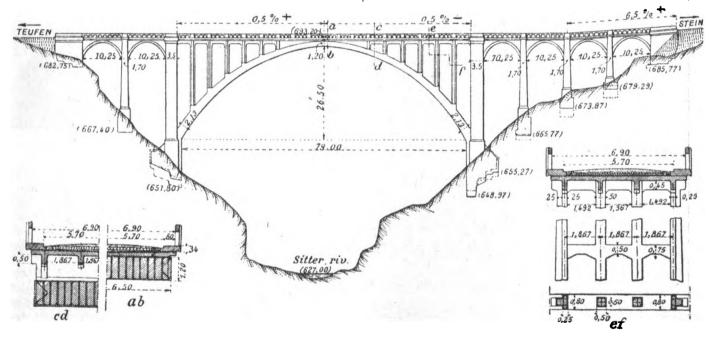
Viadotto in comento armato sui Sitter - Elevazione e sezione.
